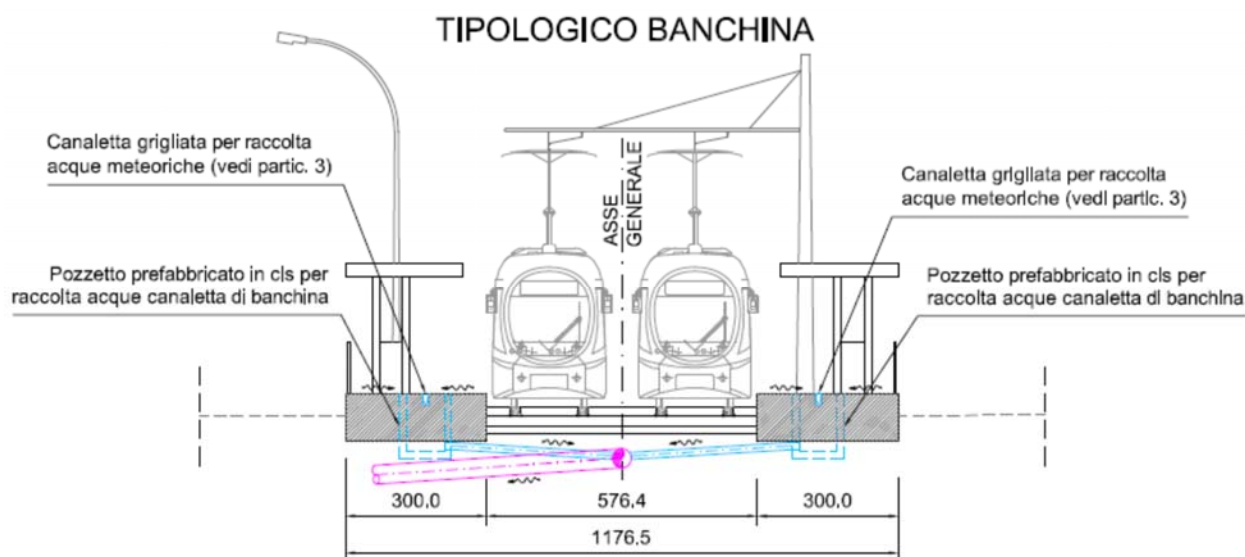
Collettamento acque meteoriche - Sezione tipo in corrispondenza delle banchine di fermata
